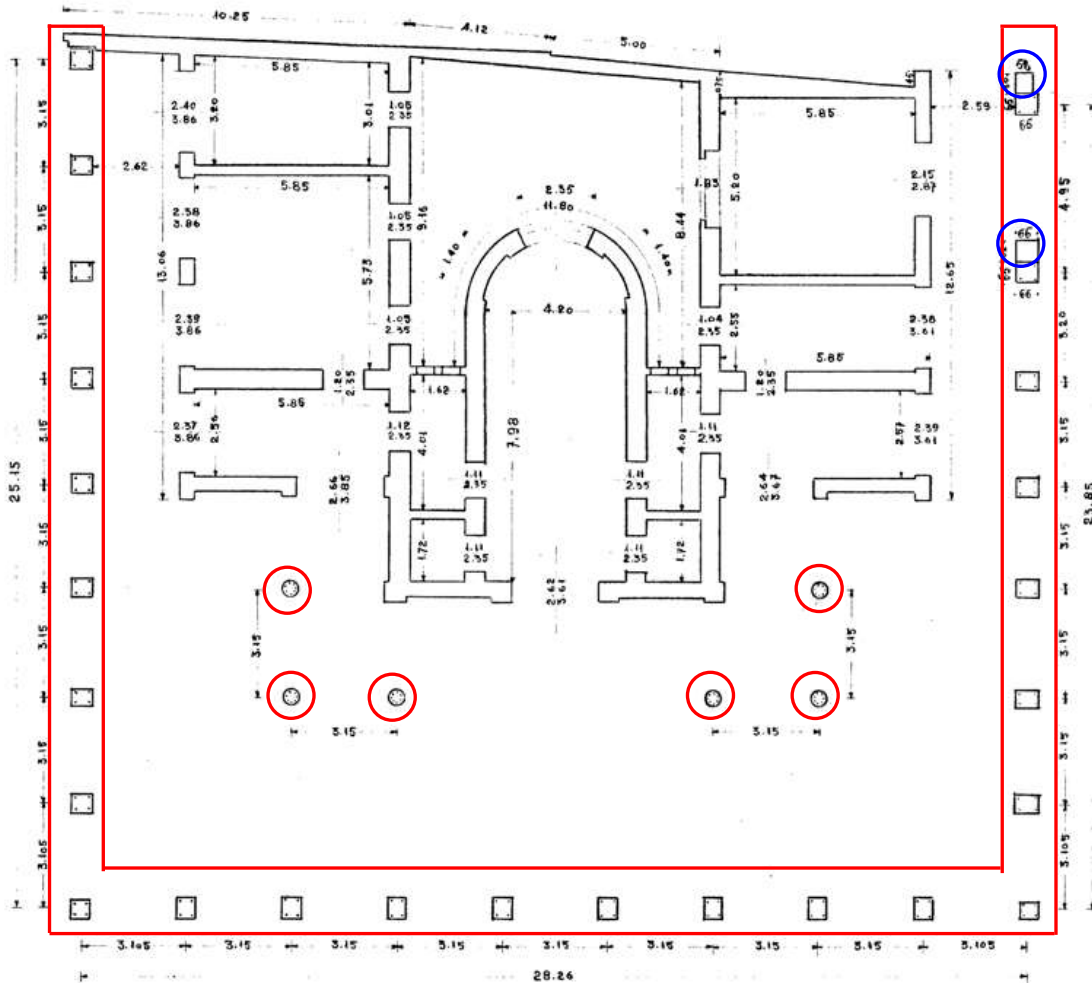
Pianta architettonica del piano terra (da progetto esecutivo del 1937), con indicazione dei pilastri in c.a. (in rosso) e di quelli in muratura (in blu).
